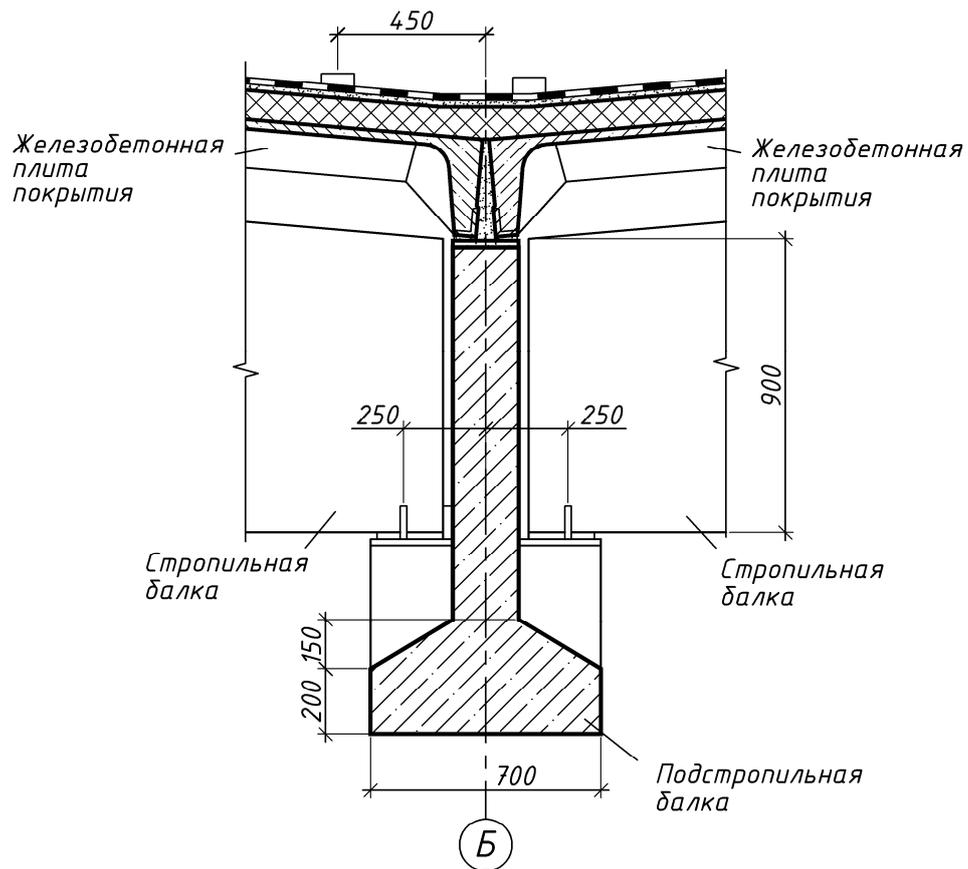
Узел опирания стропильной балки на подстропильную
